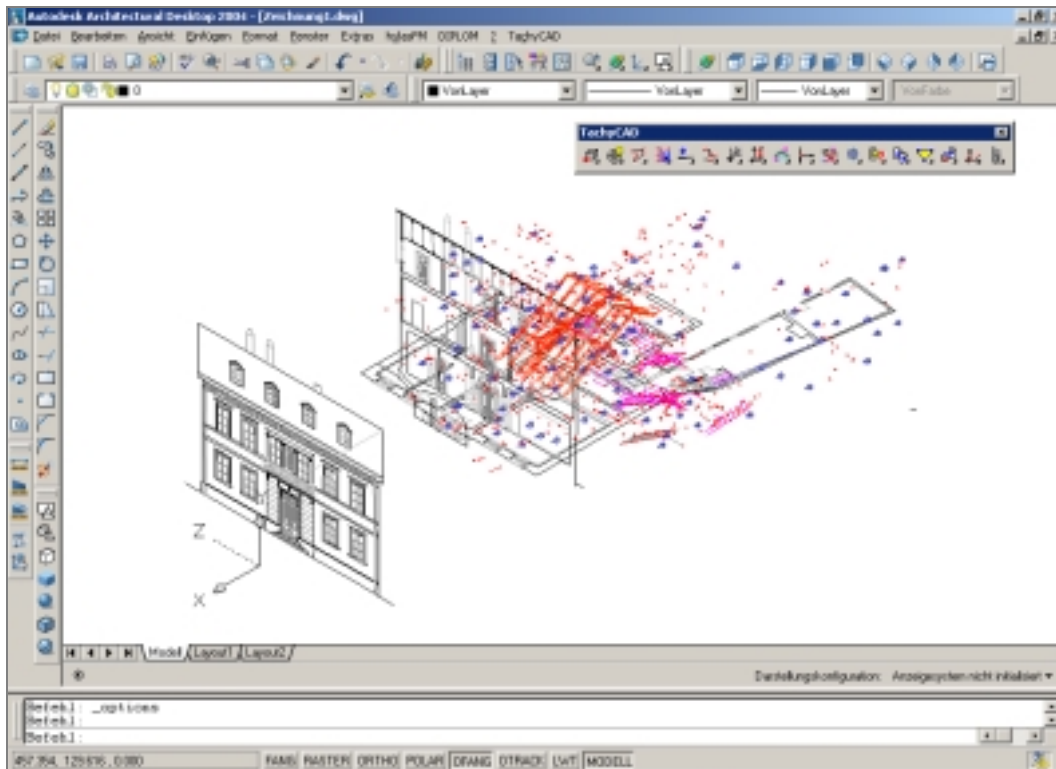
TachyCAD - zweidimensionale Grundriss-, Schnitt- und Ansichtsebene innerhalb einer tachymetrisch gemessenen dreidimensionalen Punktmenge
